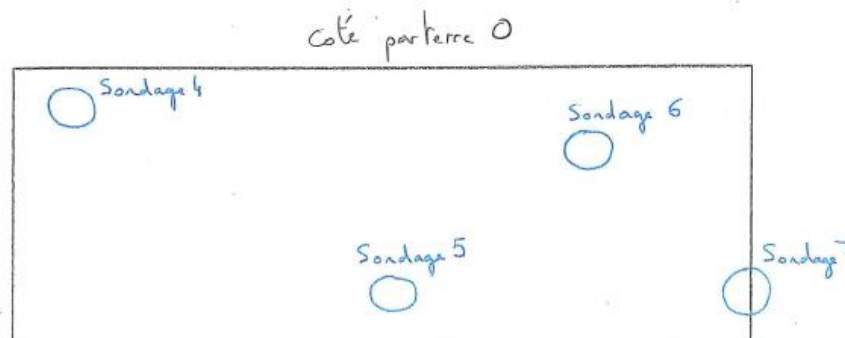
Plan de localisation des sondages – Extrait rapport Apave
